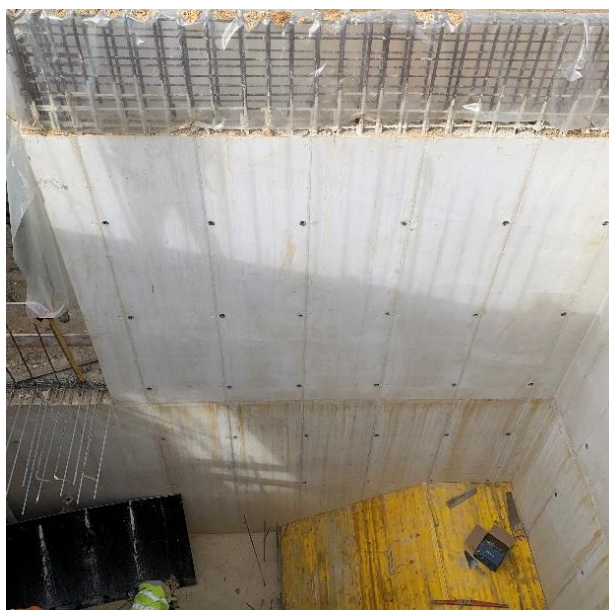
Parede em betão branco sem primário nas armaduras
